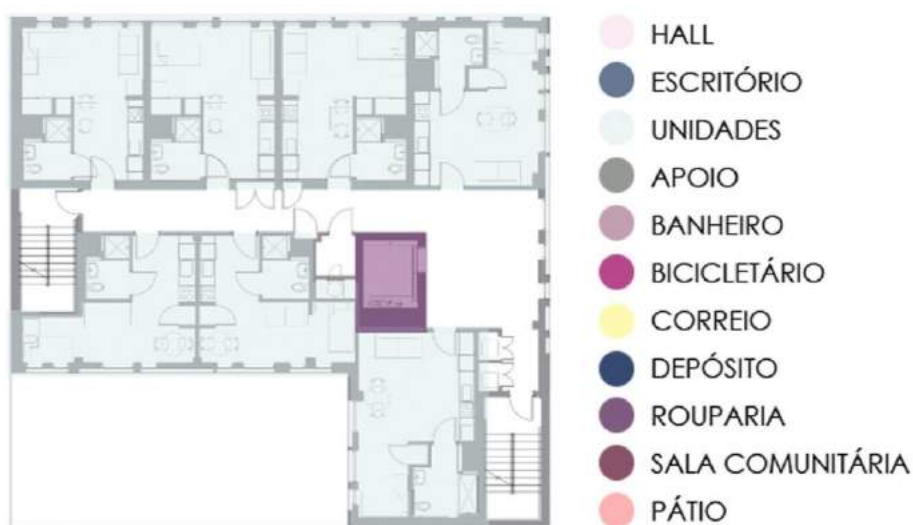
Planta tipo terceiro/sétimo pavimento setorizada. Fonte: Archdaily.
